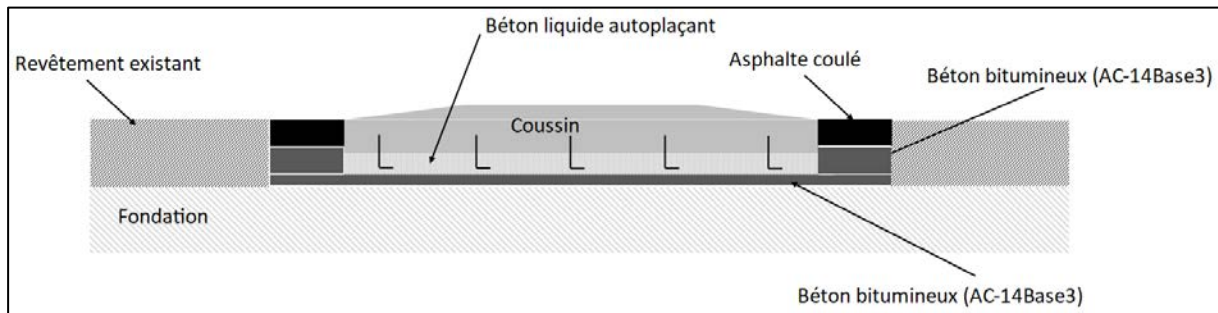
Illustration schématique de la pose d'un coussin sur une fondation en béton autoplaçant et de son resserrage par de l'asphalte coulé posé sur une couche de liaison en béton bitumineux
